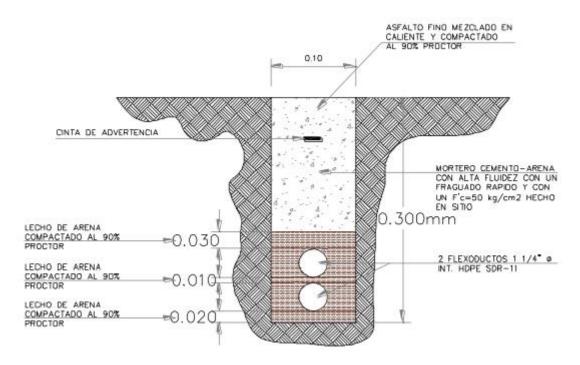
DETALLE DE LA CEPA PARA LA INSTALACIÓN SUBTERRÁNEA.
